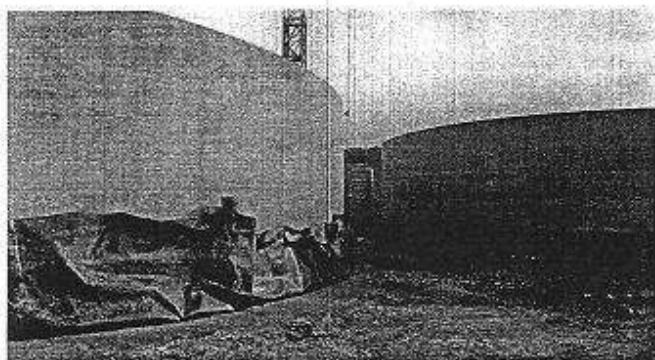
Dermbach: Leckerkennungssystem der Stahlbetonbehälter vor dem Anschütten
